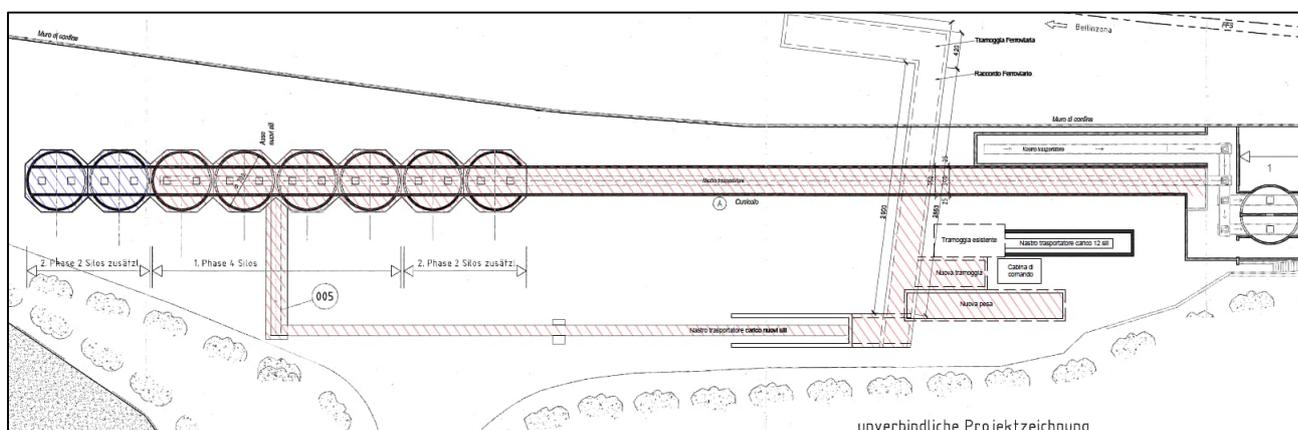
Estratto Planimetria domanda di costruzione approvata nel gennaio 2019.
